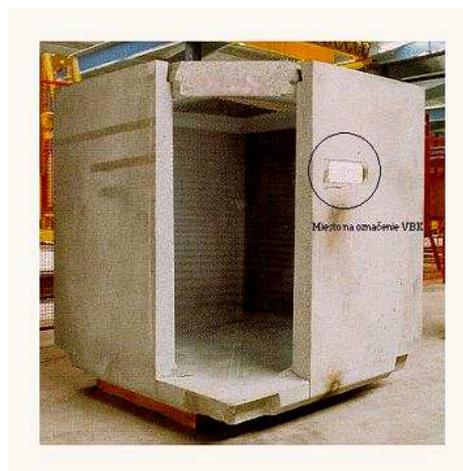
Schnitt durch den Faserbetoncontainer (FBC)
